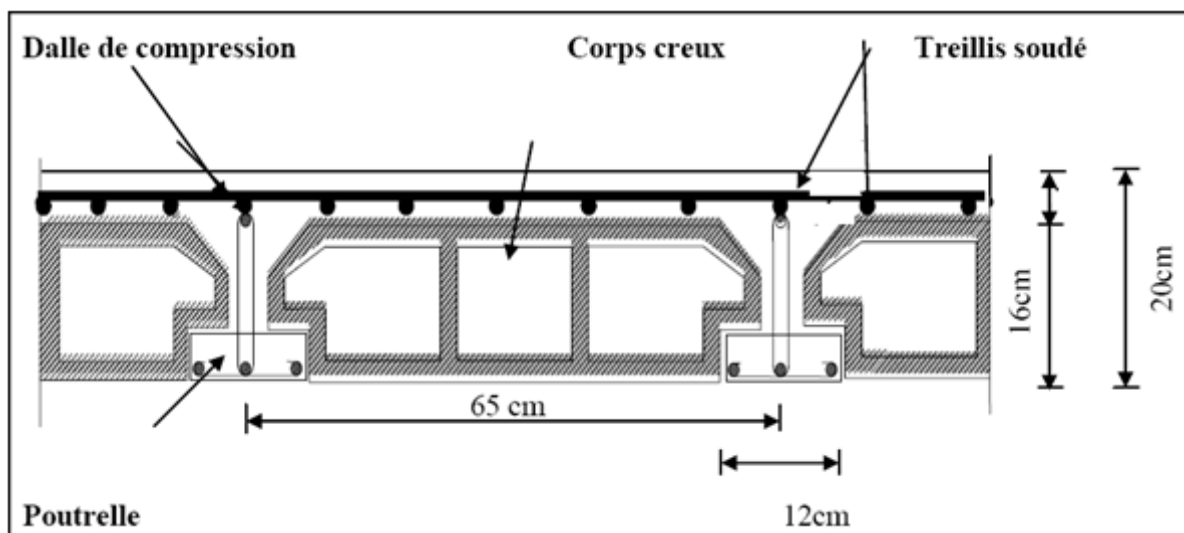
Schéma descriptif d'un plancher en corps creux.
